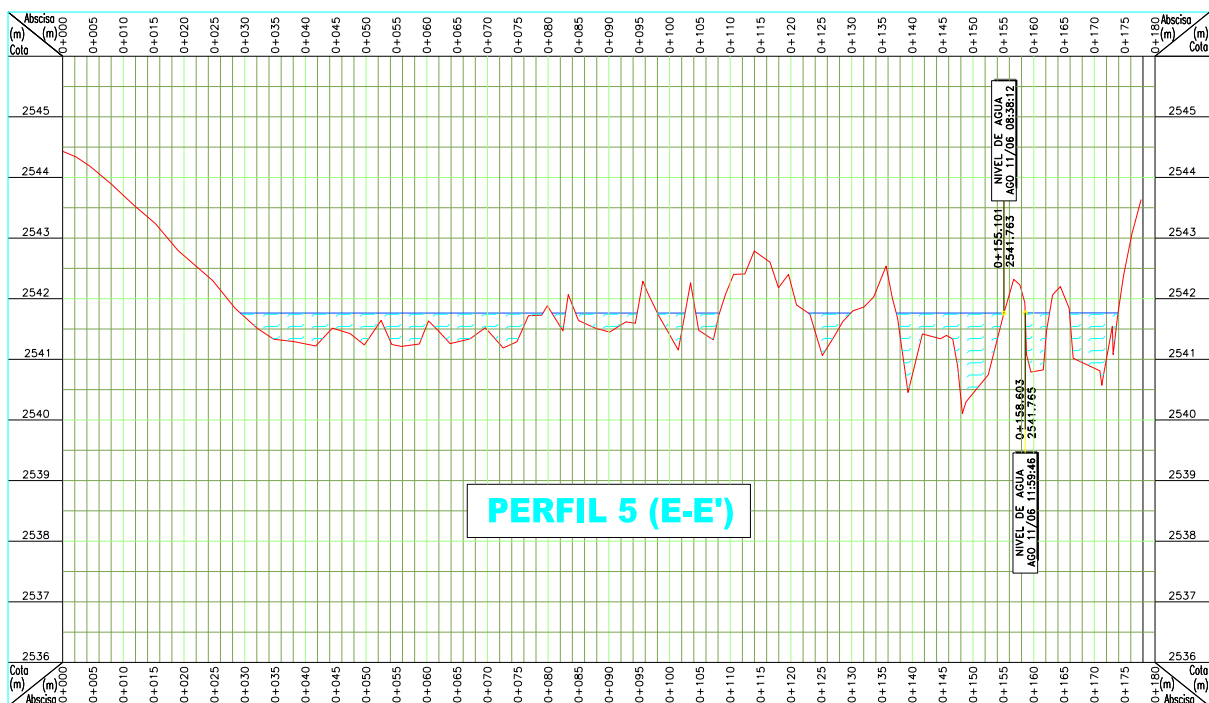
Perfil 5b. Levantado después de hacer la intervención. Unidad 3.3c.
